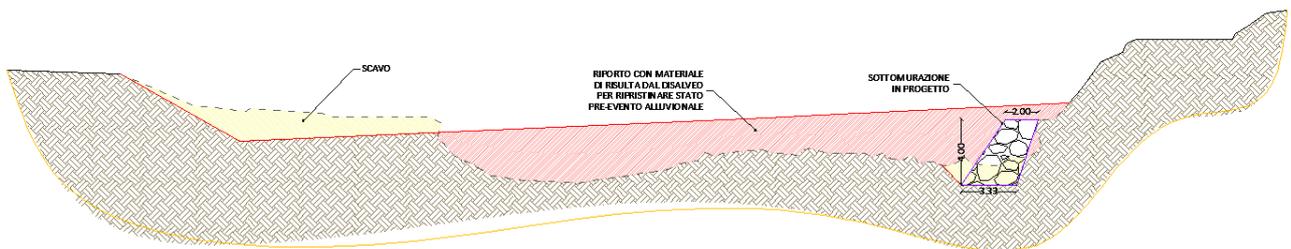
Sezione tipo 2, tratto d'alveo con sottomurazione in progetto
